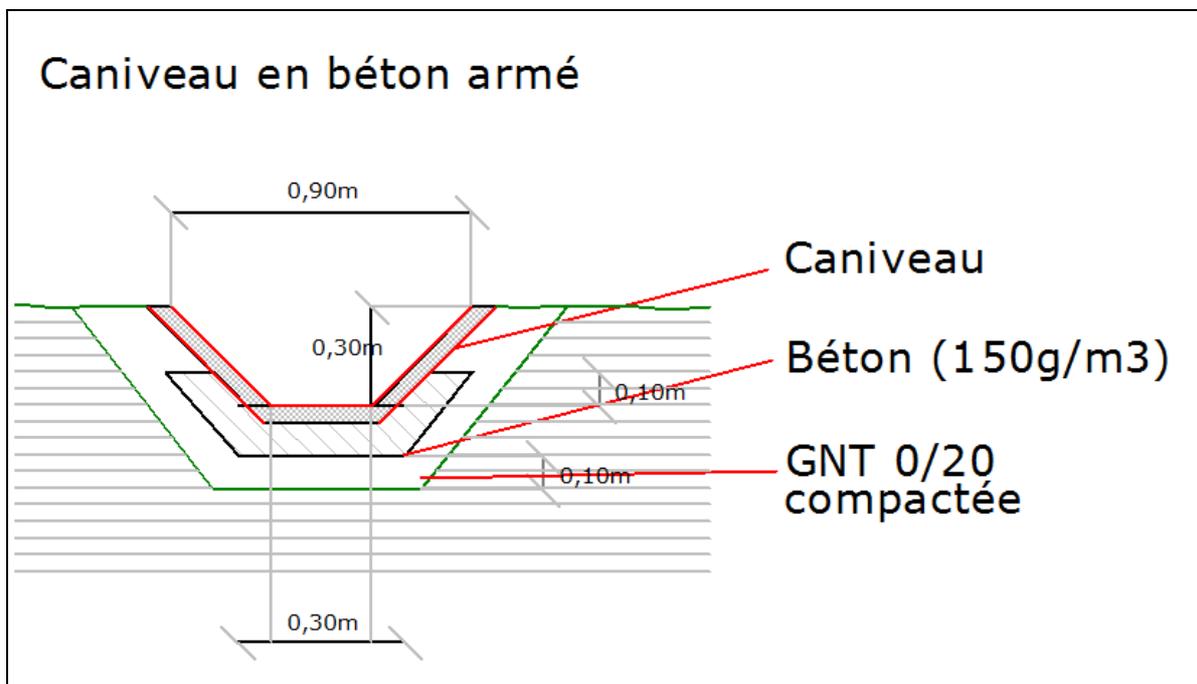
Coupe du caniveau Cd2 en béton préfabriqué
